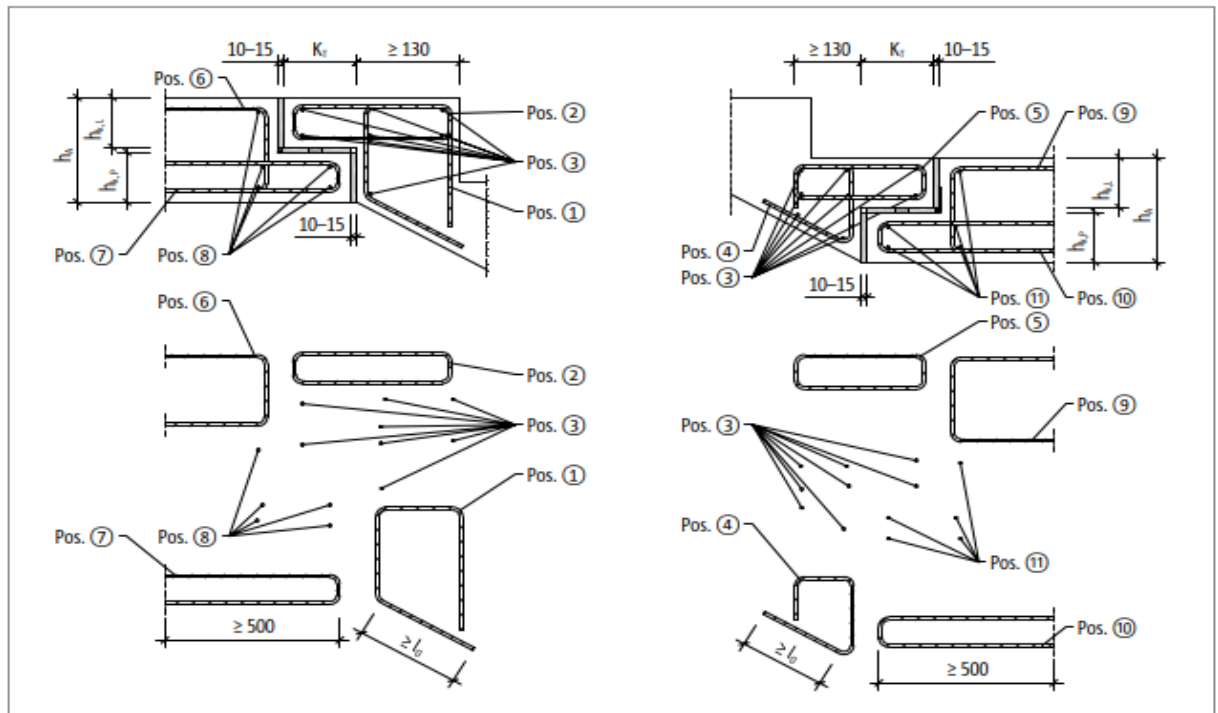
Schöck Tronsole® Typ F: Bauseitige Bewehrung bei bündigem Anschluss
